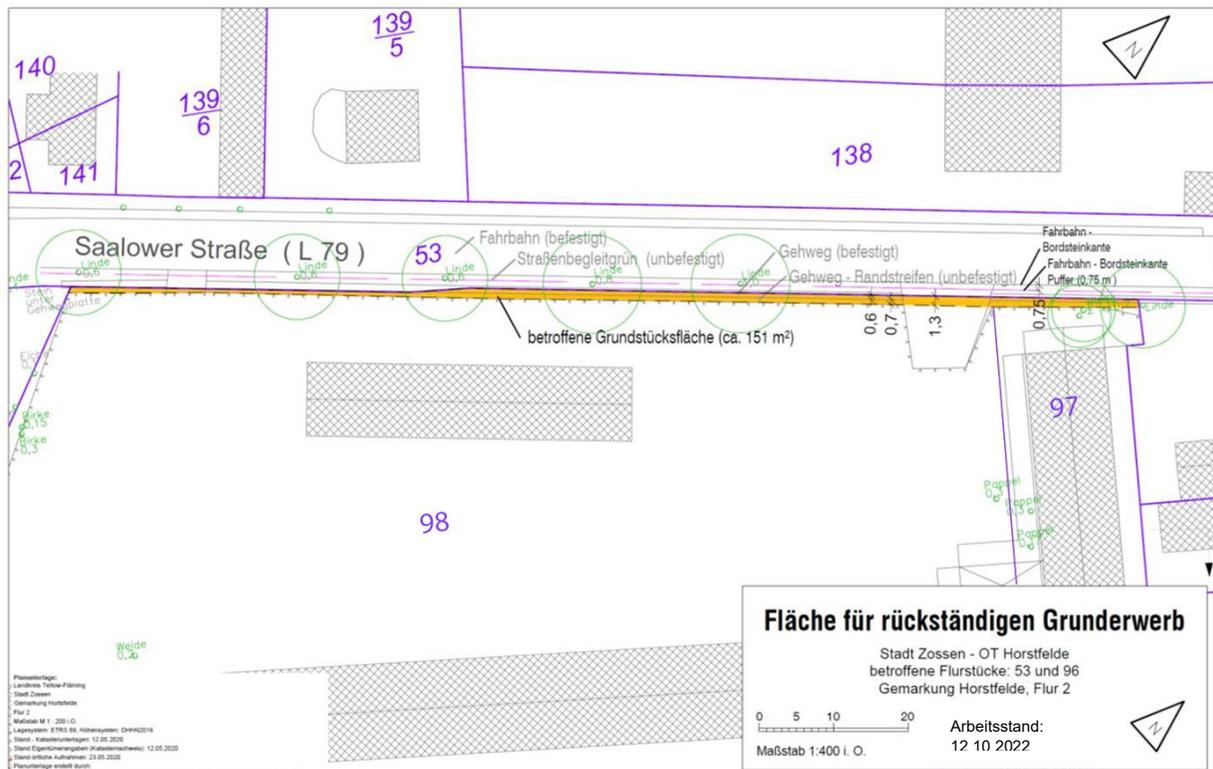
Darstellung Fläche für rückständigen Grundstückserwerb (dunkelgelbe Fläche); Quelle: Vermessungsgrundlage, eigene Anpassung.
